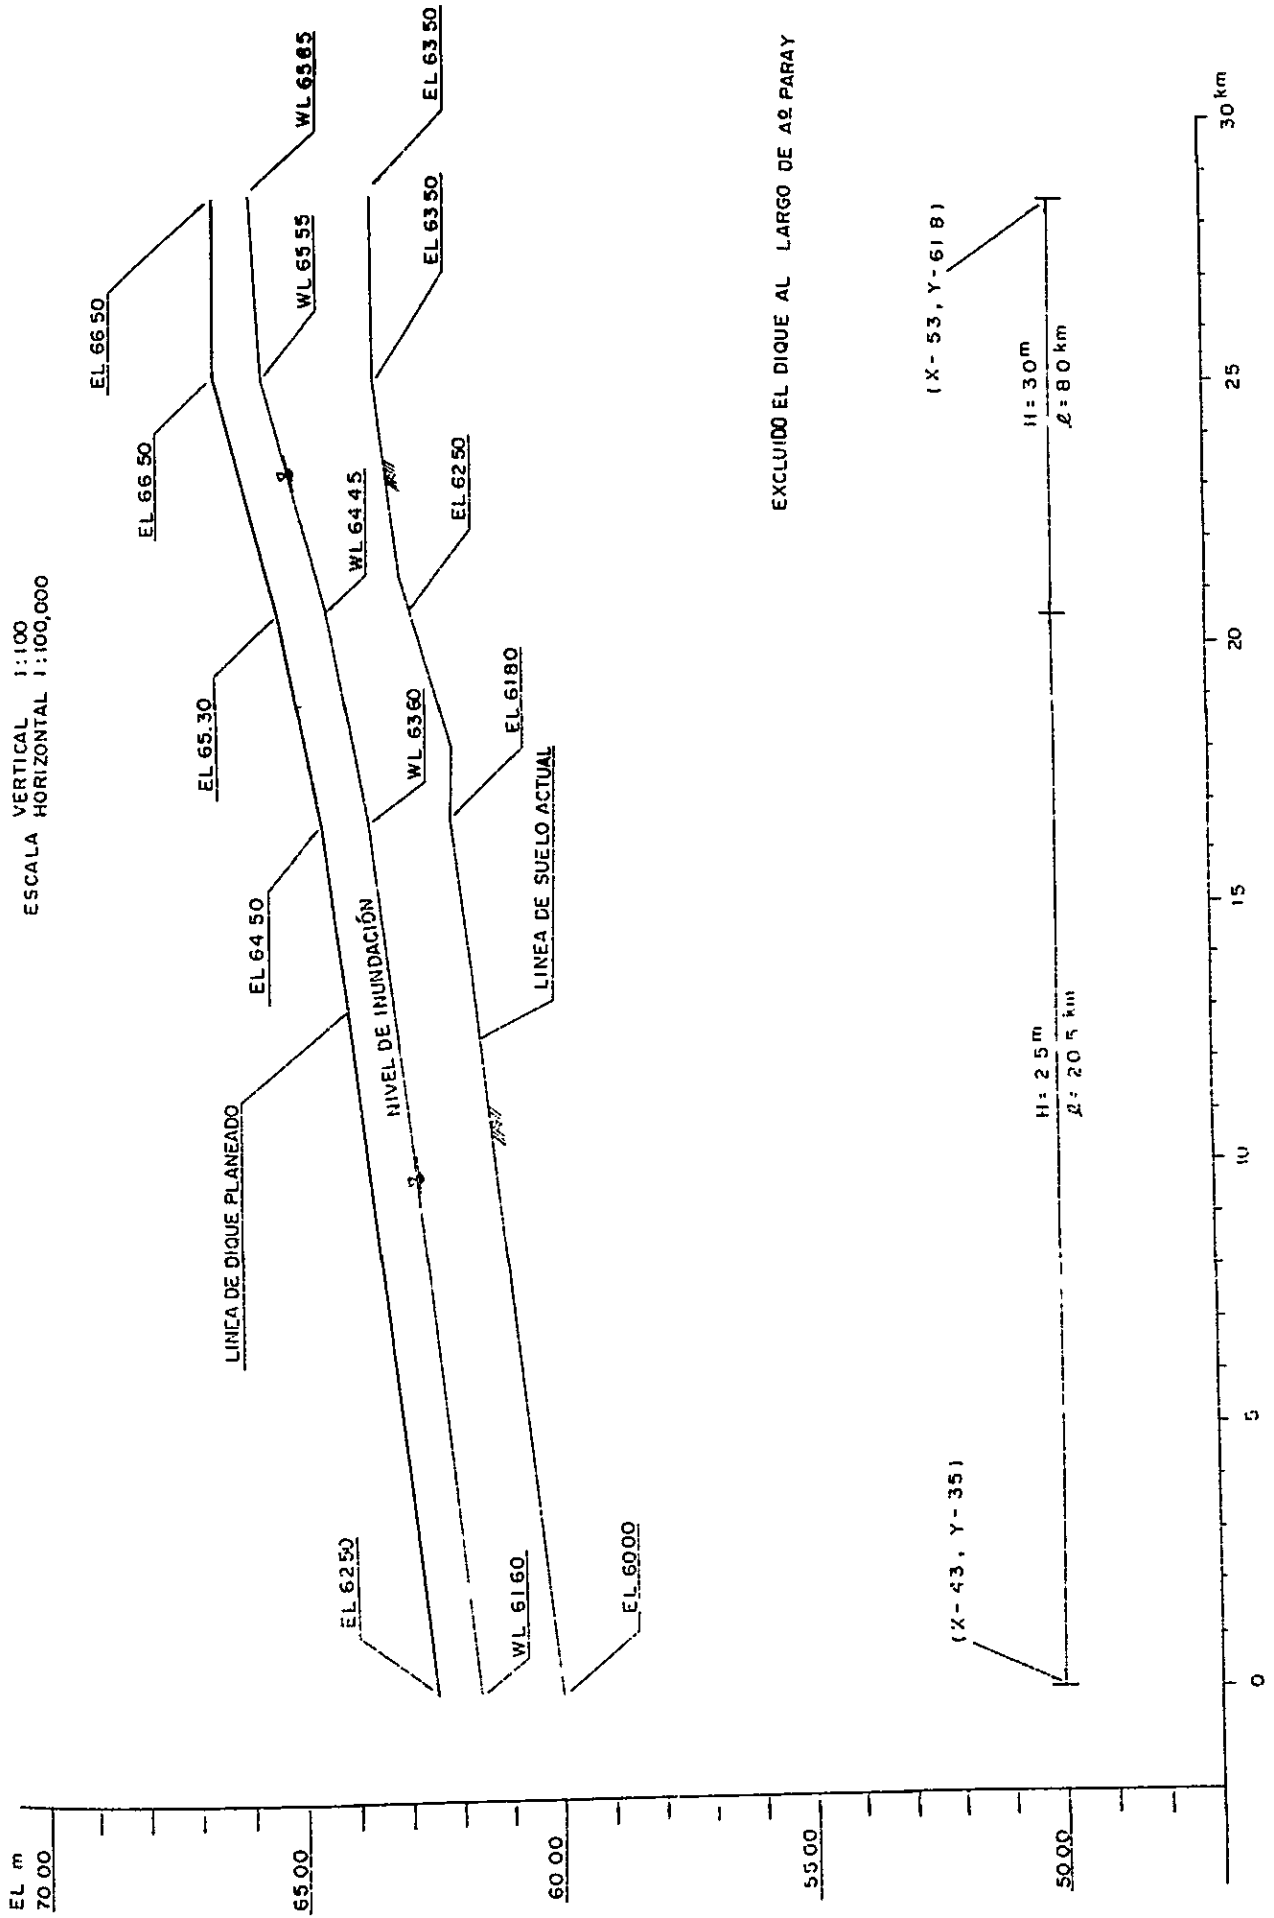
PLANO DE SECCIÓN VERTICAL DE DIQUE EN EL PLAN RODEADO DE DIQUE (CASO 2)
